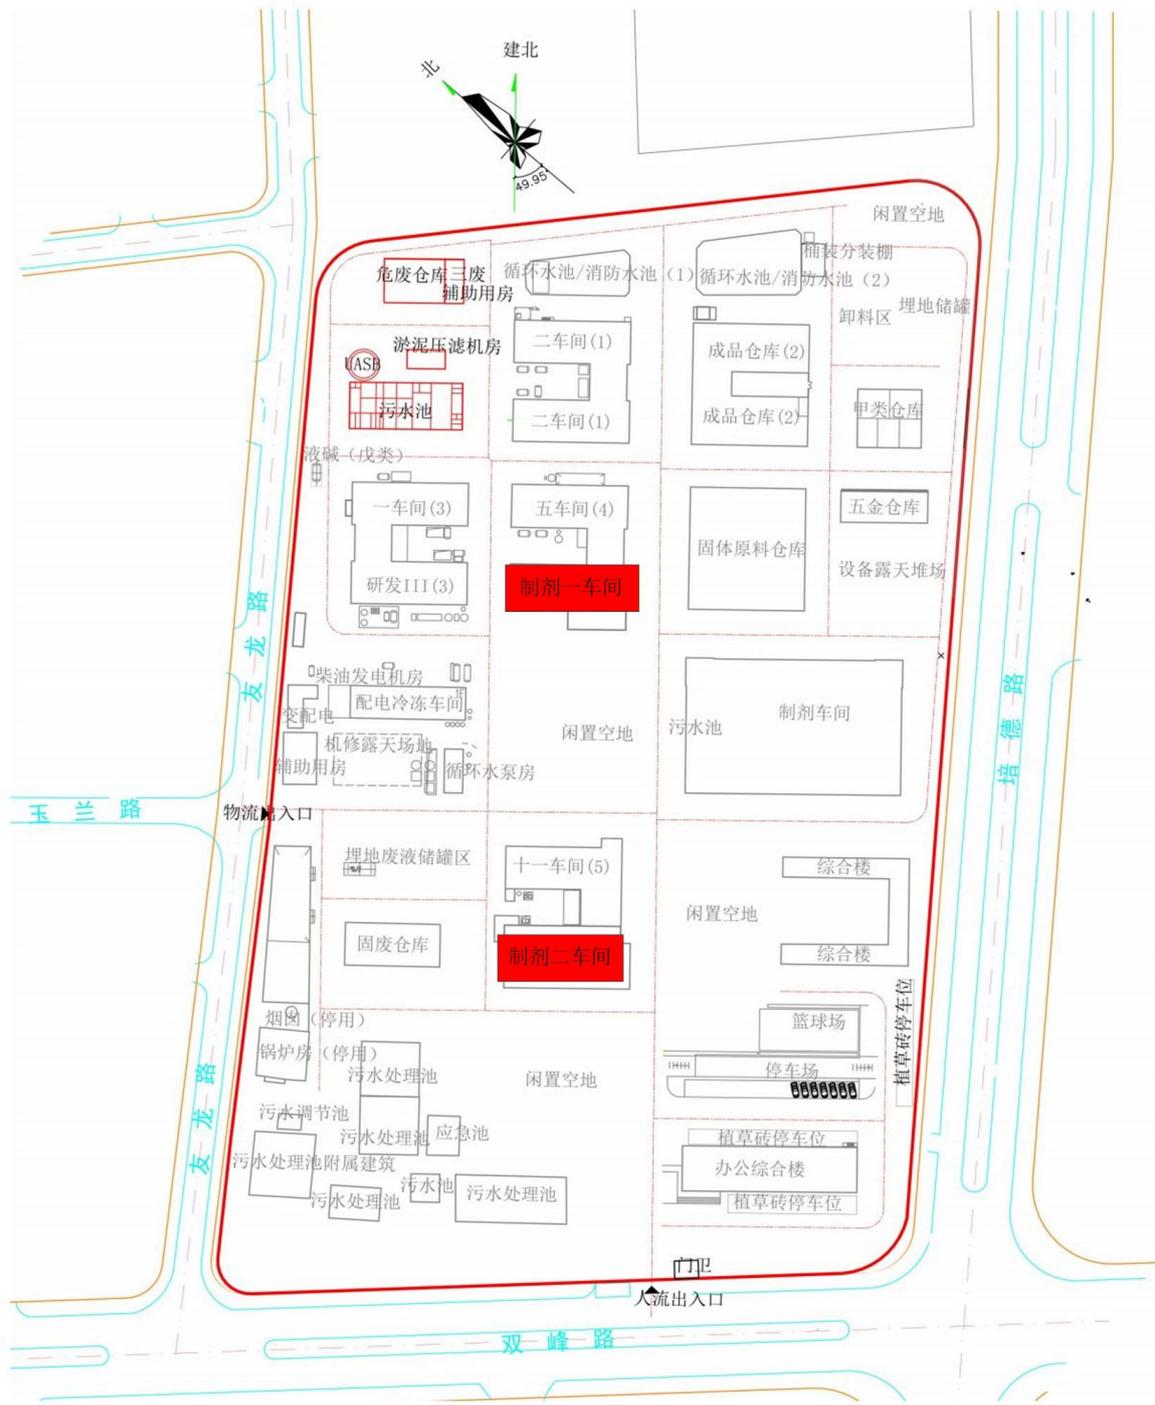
本项目实际厂区平面布置（填充色块区）
